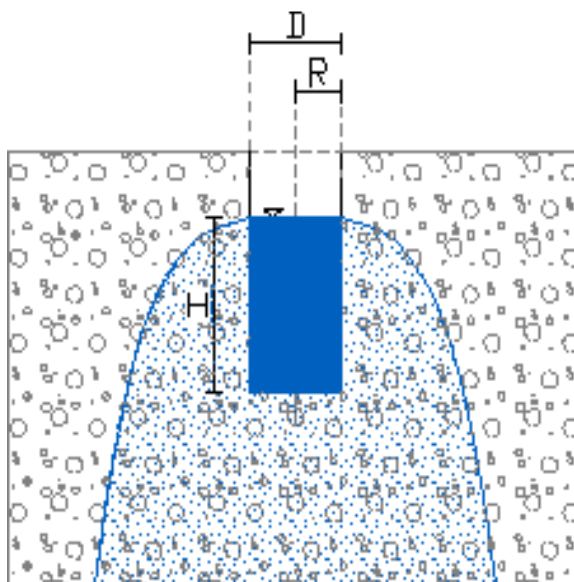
Schema funzionamento di un pozzo drenante
